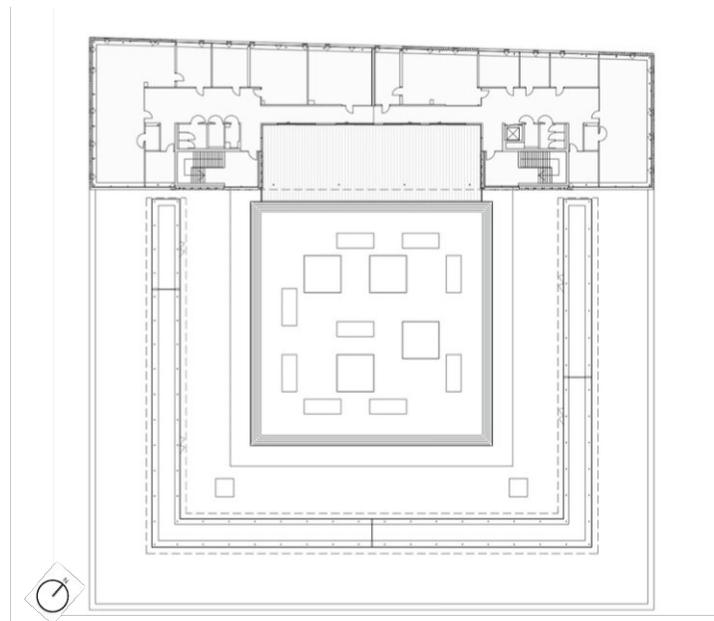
Grundriss, 3. Obergeschoss, Dachterrasse als offener Platz für Soziale Interaktionen
